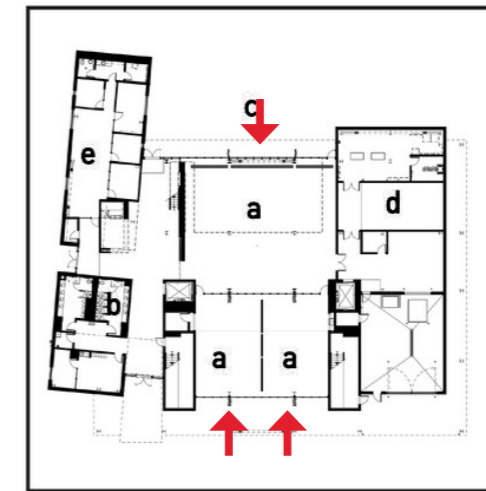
INDICAÇÃO DE ACESSO AO CENTRO DE ARTES // PLANTA TERREO
